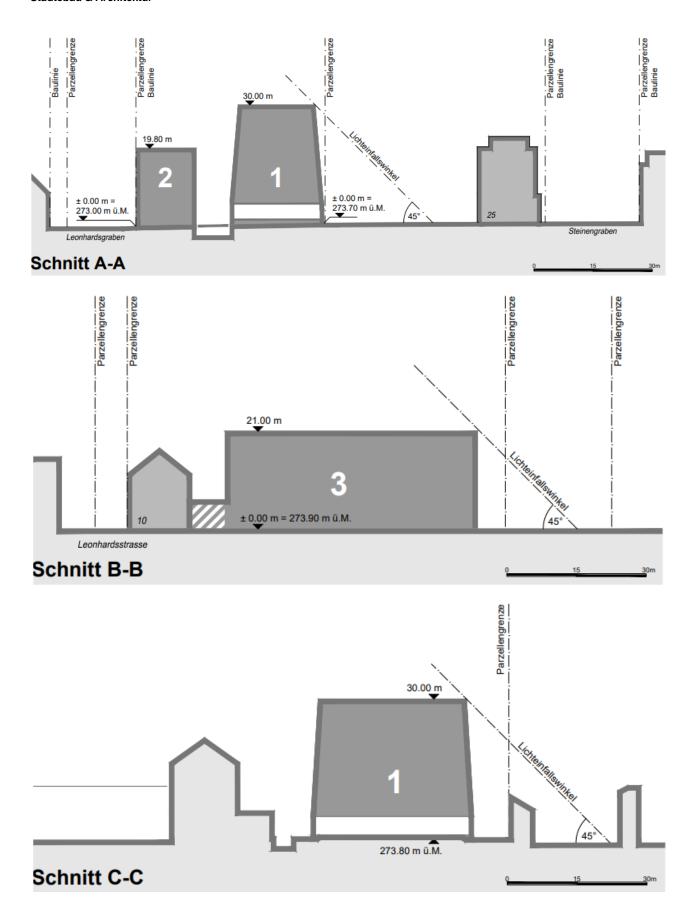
Schnitte AA, B-B, CC Bebauungsplan Nr. xxx. (Quelle: S&A, 2025)
